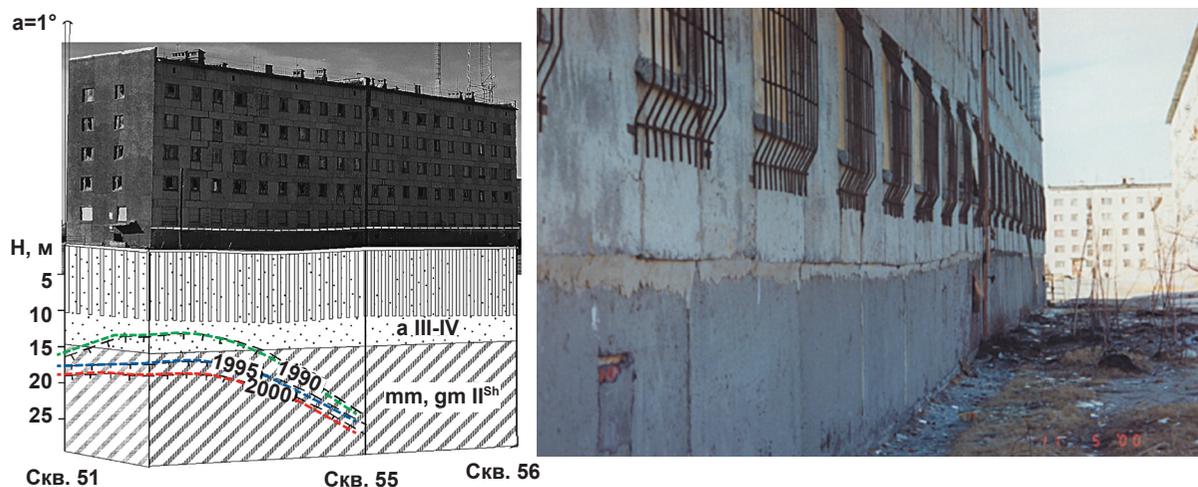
Деградация ММГ в основании жилого дома на свайном фундаменте и неравномерная осадка здания (Надым, микрорайон IV-а)
